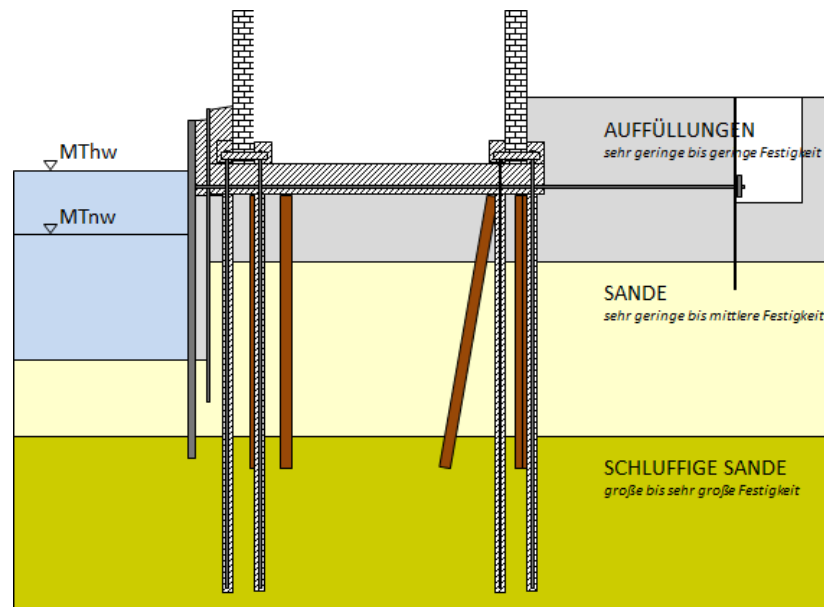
Variante 2: Unterfangung mit Pfahlkonstruktionen
